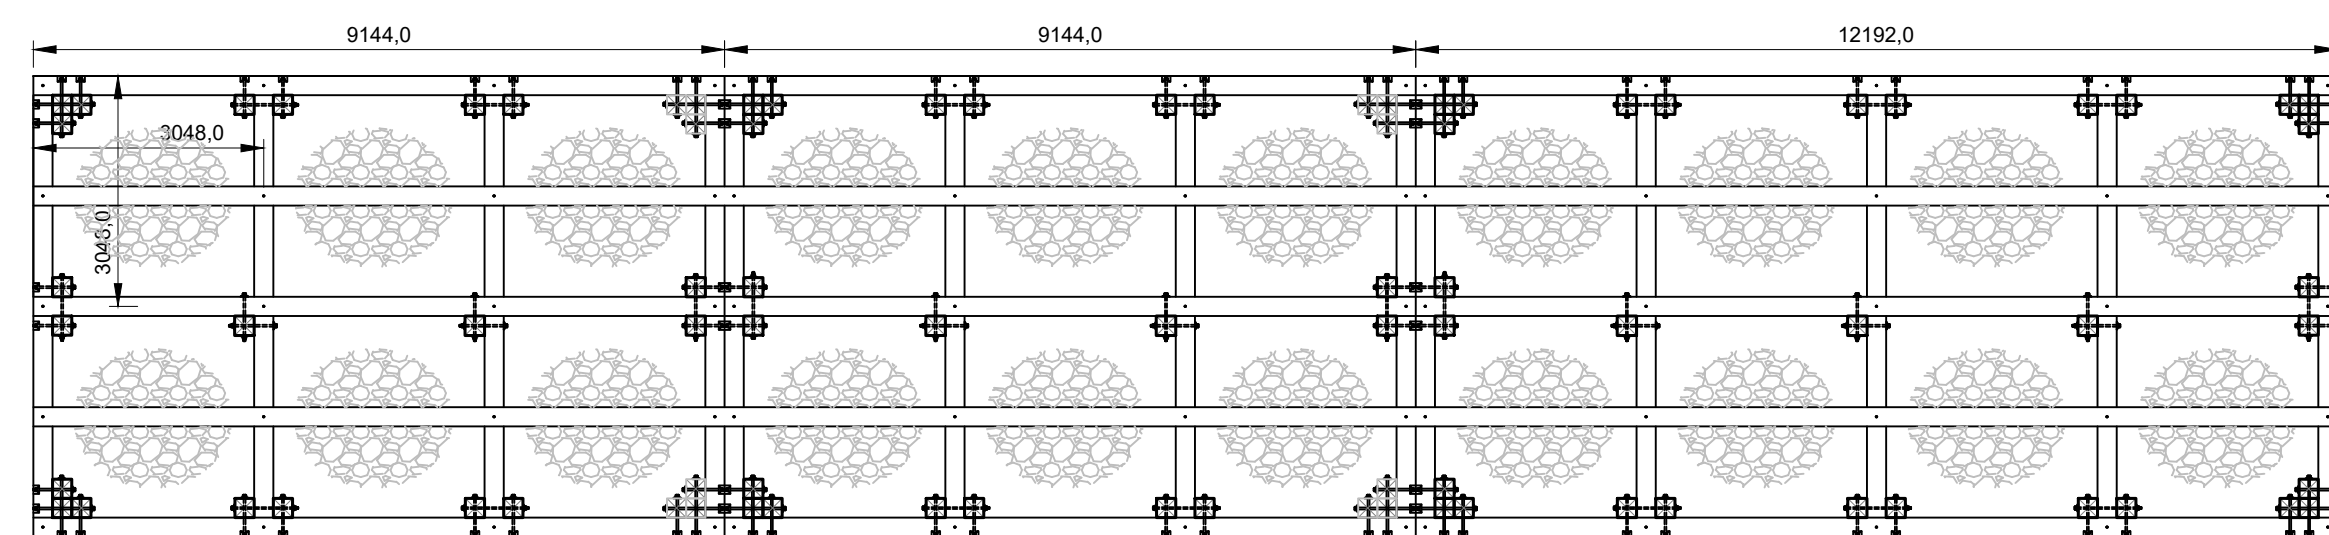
DETAIL ENCAISSEMENT (QUAI #1 ET #2)
